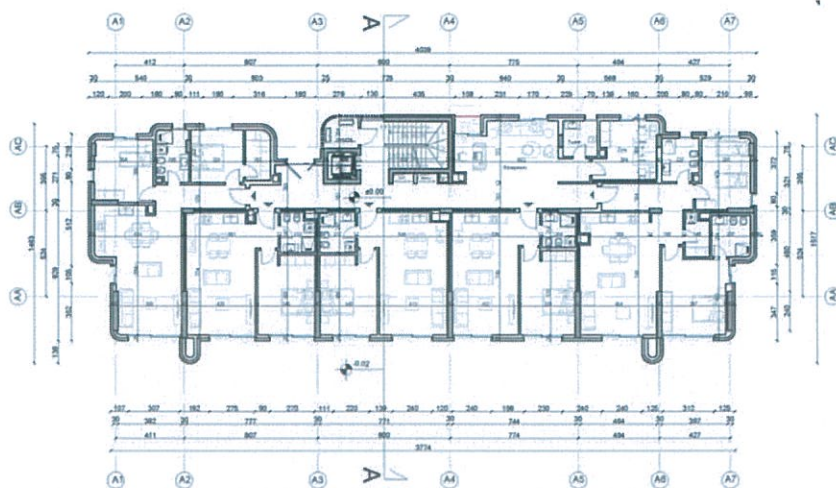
Planimetria e katiit perdhe Apart-Hotel (Objekti A).
